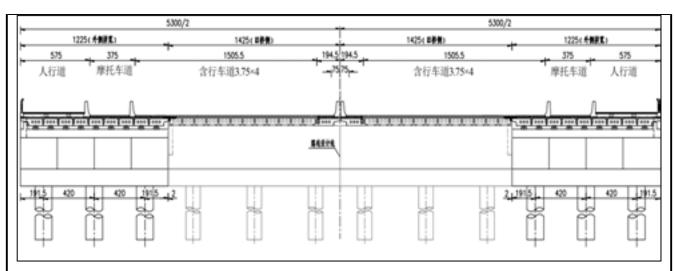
城区段对称拼宽桥梁标准横断面示意图
